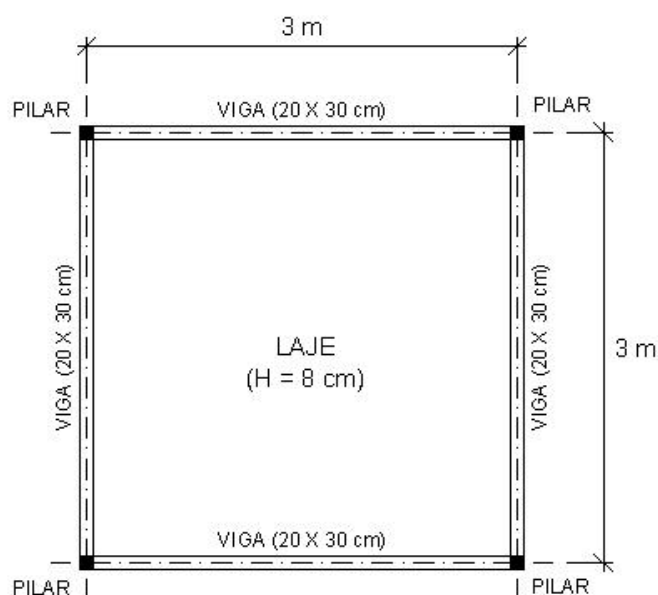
Laje maciça apoiada em vigas consideradas deformáveis verticalmente [37]
